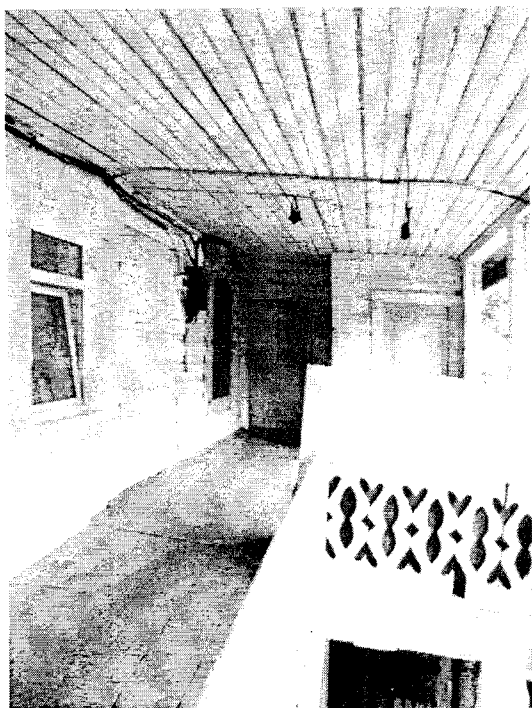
, 23 - Фрагменты продольного, дворового (северо-восточного) фасада жилого дома (лит. А). Оконные проемы
